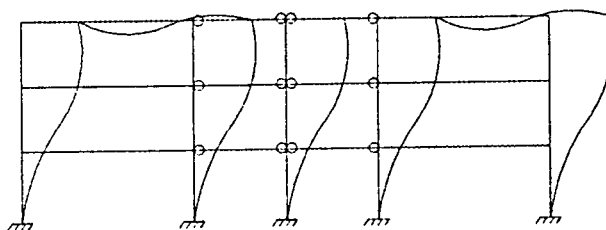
Configuração de instabilidade - Nelson Vila Pouca.
